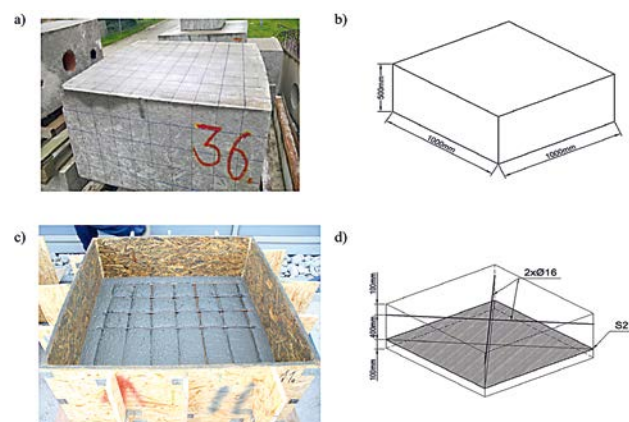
Element betonowy P19: a) element wraz z wymiarami próbki, b) wymiary próbki wraz z zabetonowanym elementem, c) zabetonowane wtrącenie, d) wymiary zabetonowanego elementu
